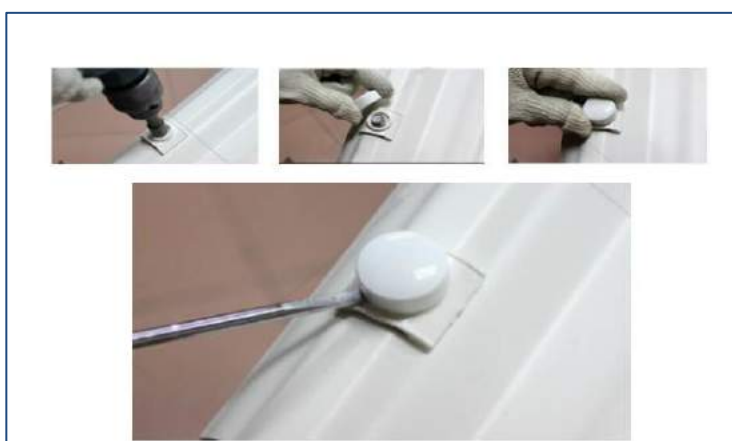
Colocación de la pija.* En la imagen se aprecia la parte en donde se debe de instalar la pija en la cresta trapezoidal.
